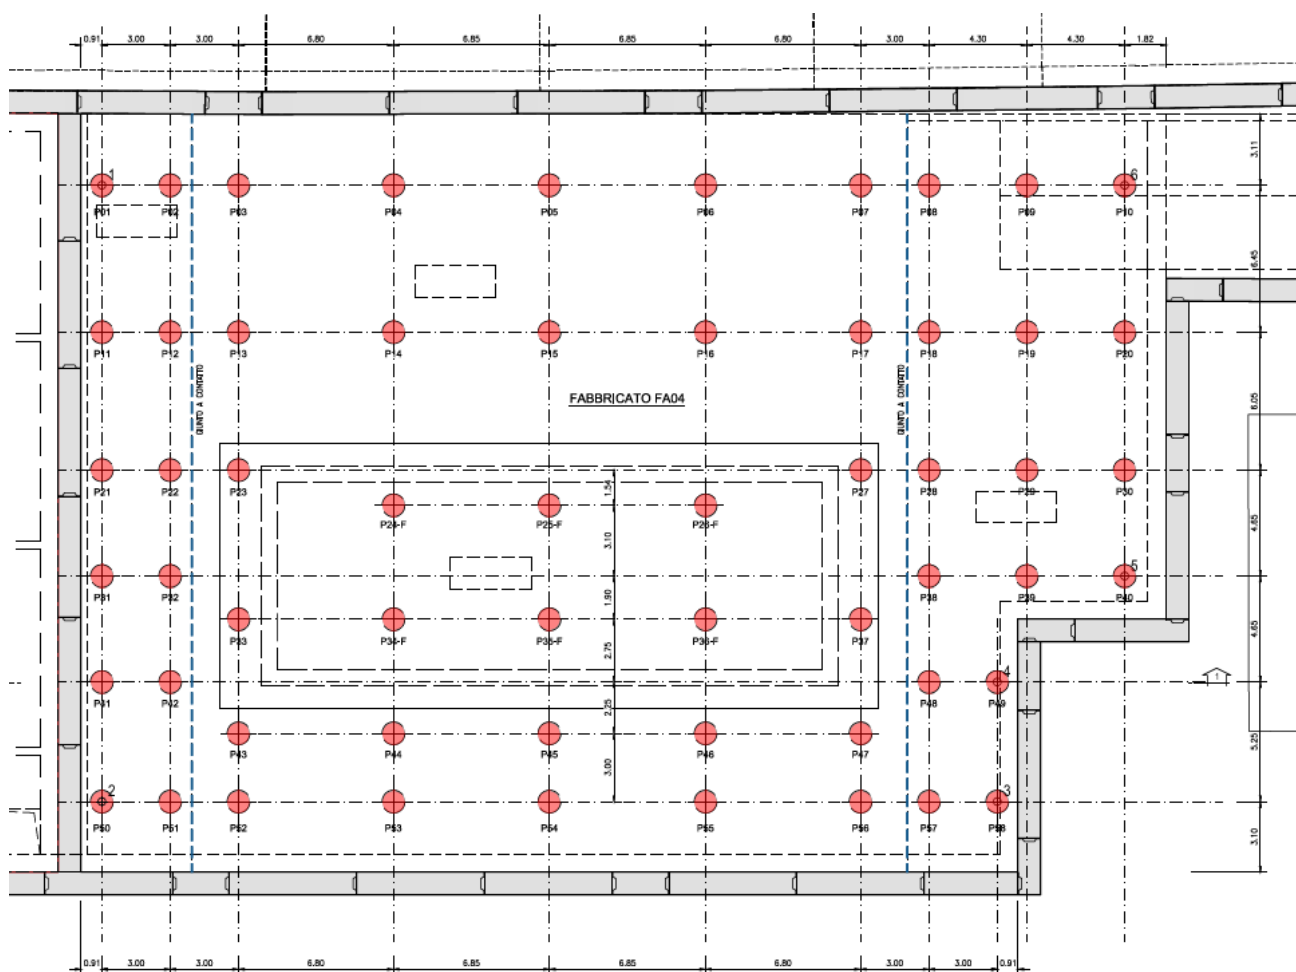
Planimetria pali di fondazione piazzale quota piano ferro
